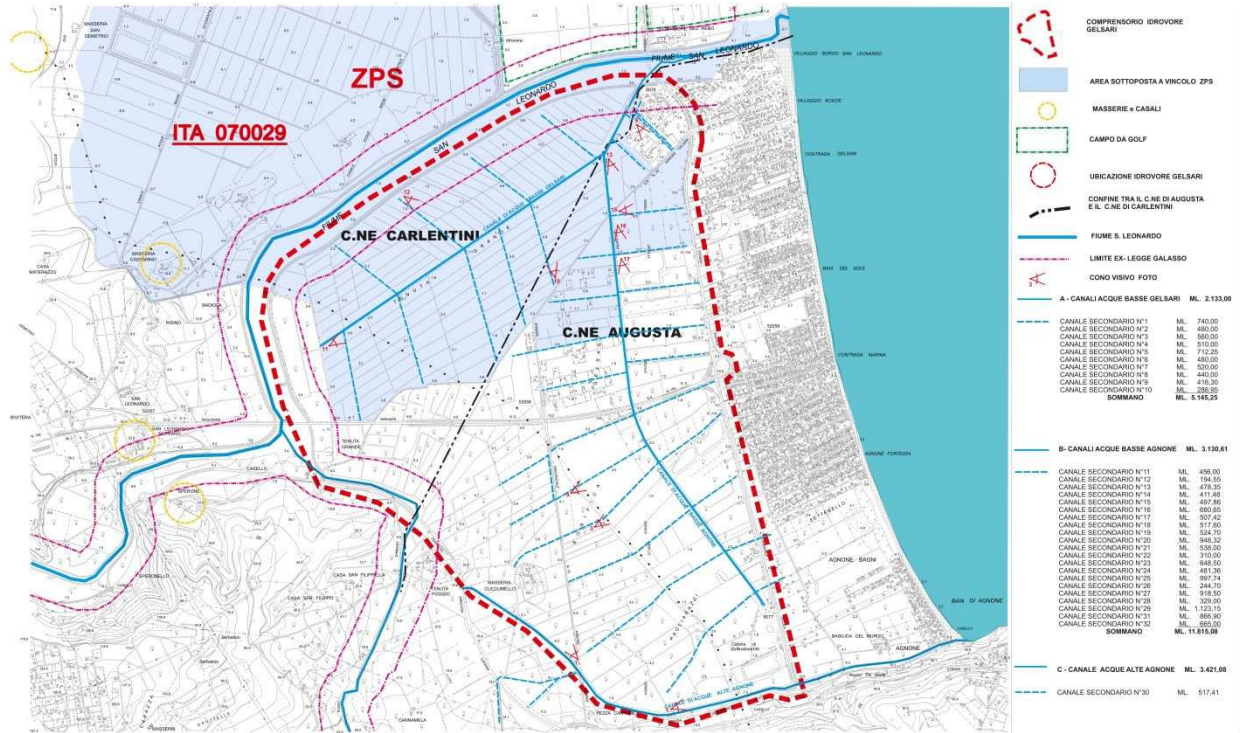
\_ STRALCIO DEL COMPENSORIO PANTANO GELSARI\_ PLANIMETRIA GENERALE
